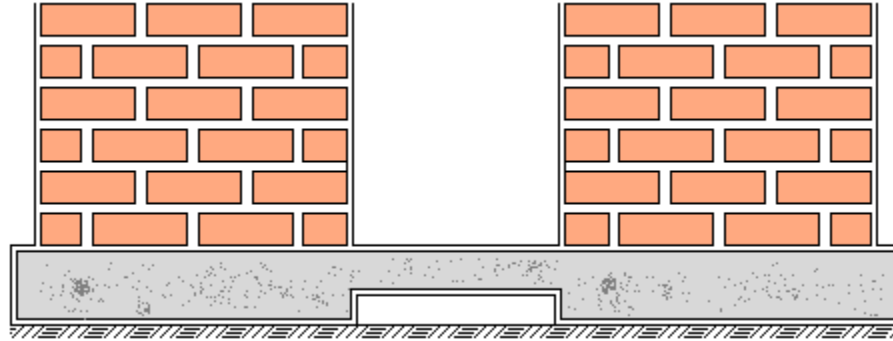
Detalle donde se indica la interrupción del apoyo en una zapata continua cuando se presentan vanos en la mampostería
